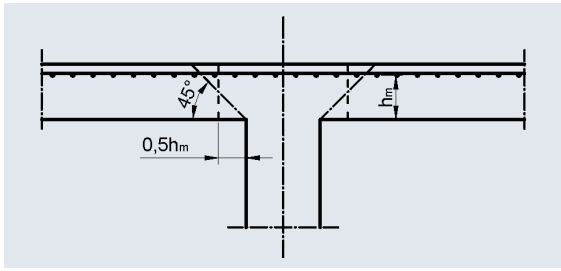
Obere Biegezugbewehrung auf den Obergurten der Filigran-Durchstanzbewehrung
